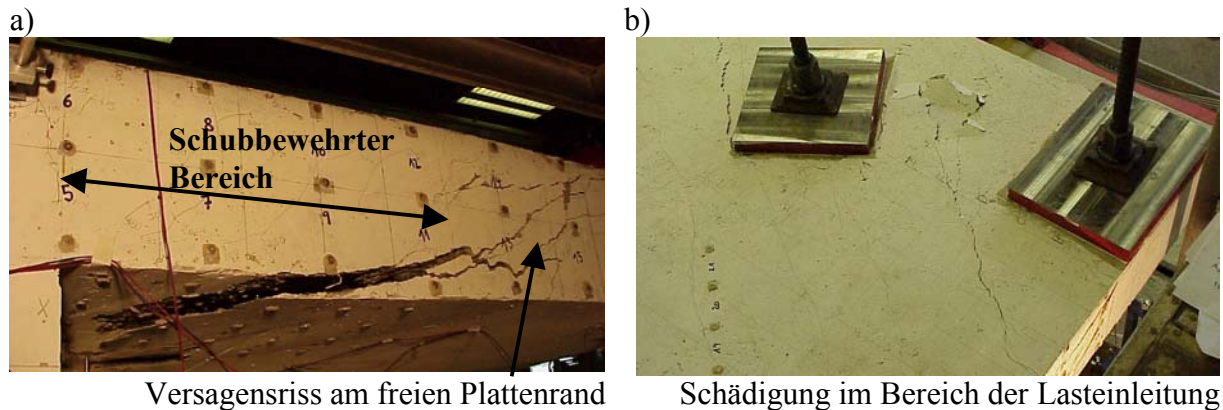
Versagen außerhalb des schubbewehrten Bereiches
